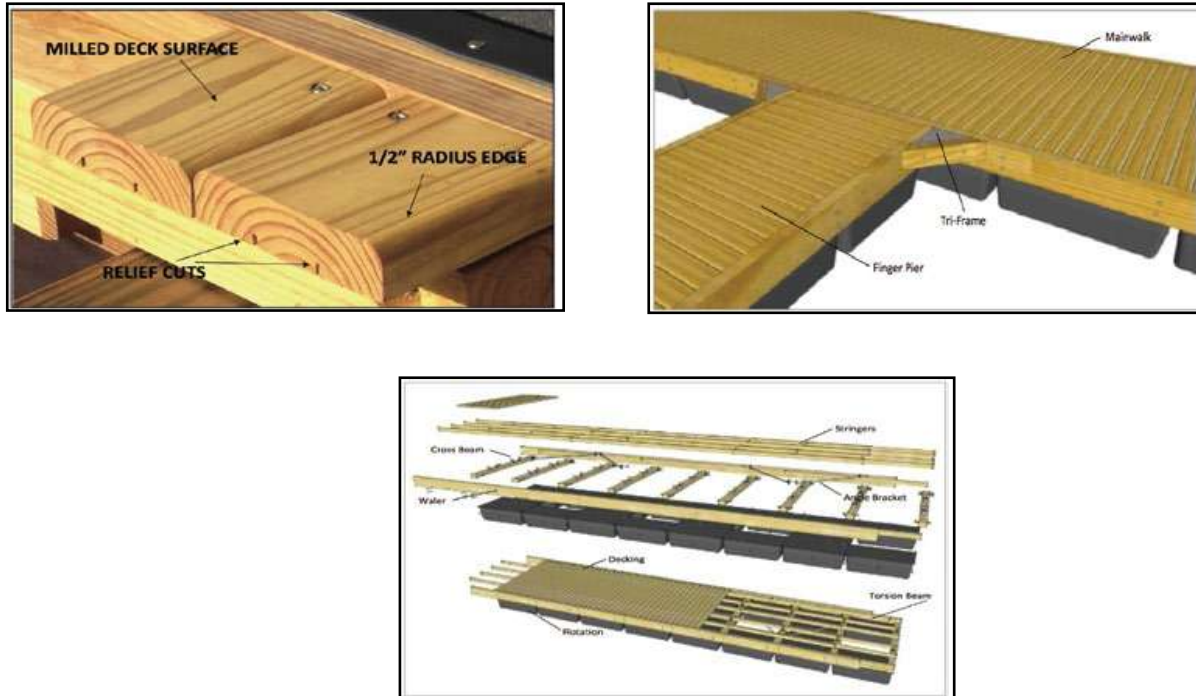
Figuras detalles constructivos de los muelles flotantes proyectados.
